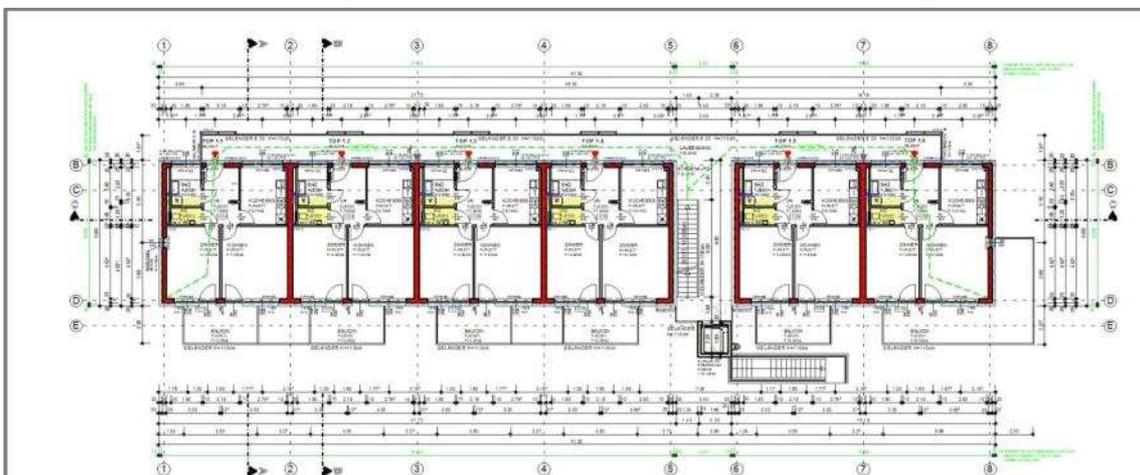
Einreichplan – Grundriss 1. bis 3. Obergeschoß (Regelgeschoß)²⁵²
